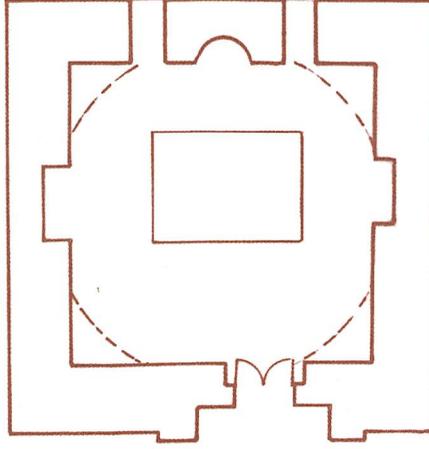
المسقط الأفقى لمسجد زاوية الباشا برشيد
